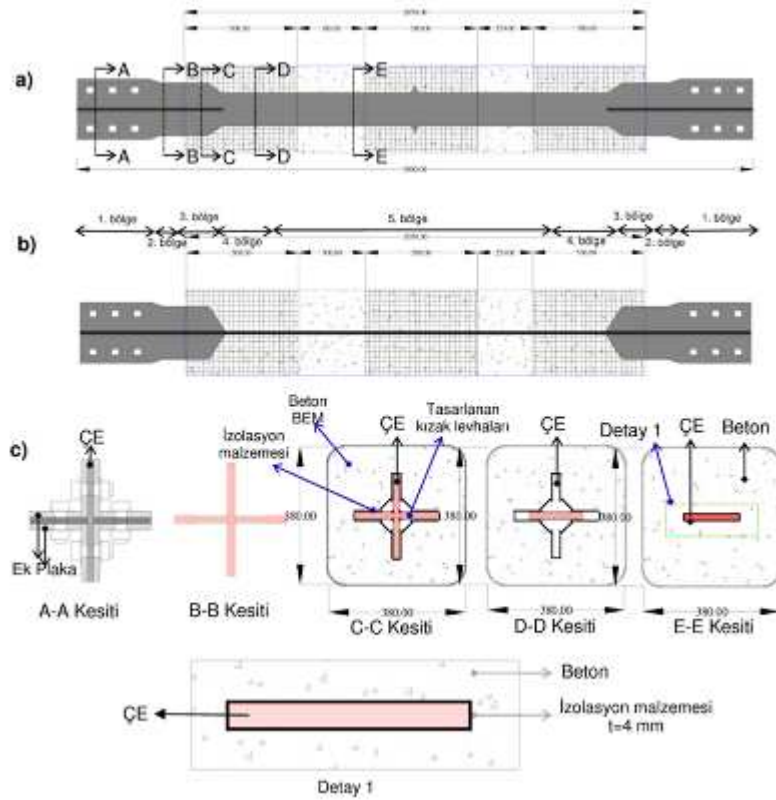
7. BEÇÇ\_1 elemanı detay çizimleri
